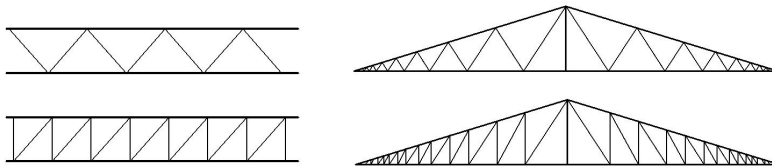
Elevaciones de los joist y tijeras mas utilizadas.
